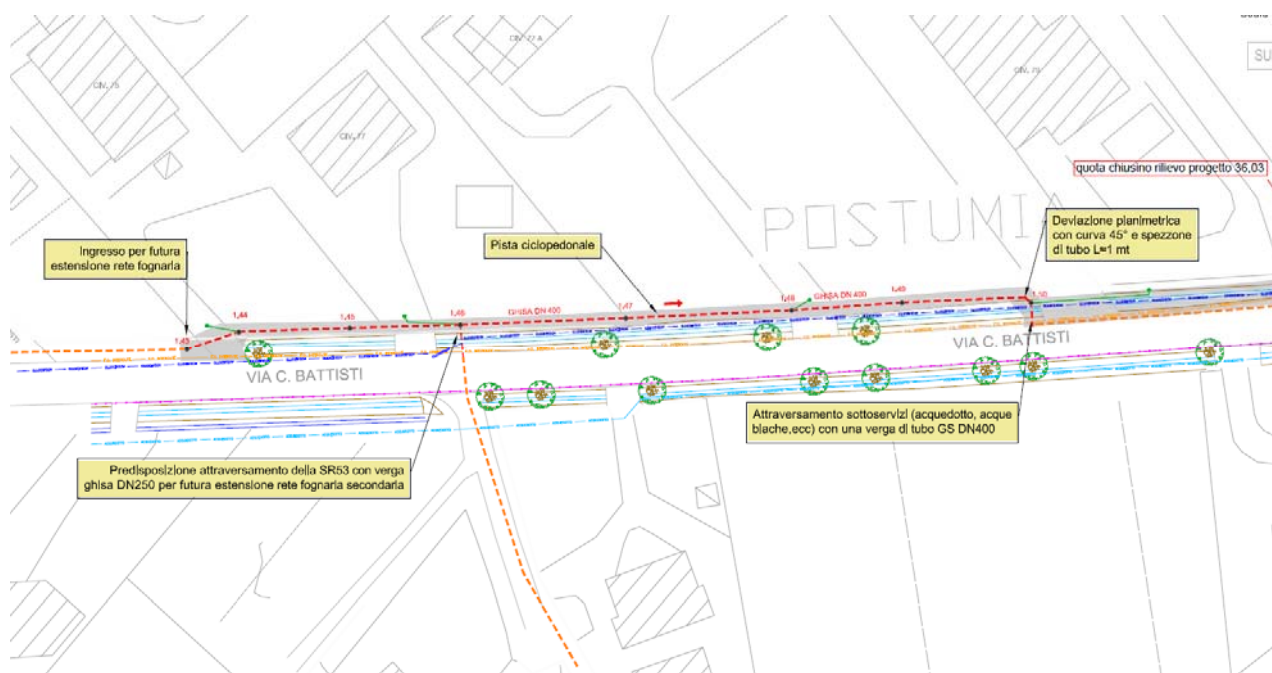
Progetto ATS – Planimetria del tratto di condotta fognaria in via di realizzazione
